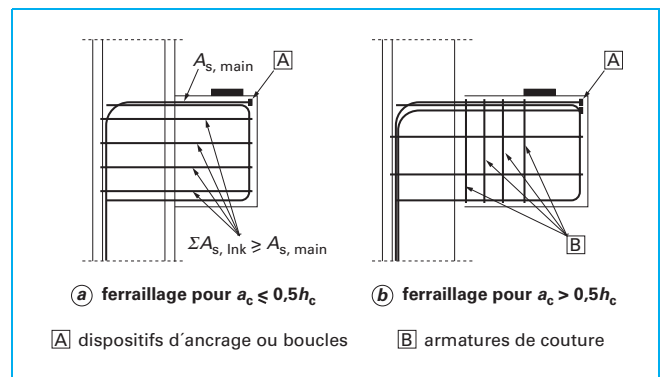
Dispositions constructives pour une console courte (figure J6 de l'EC2)
